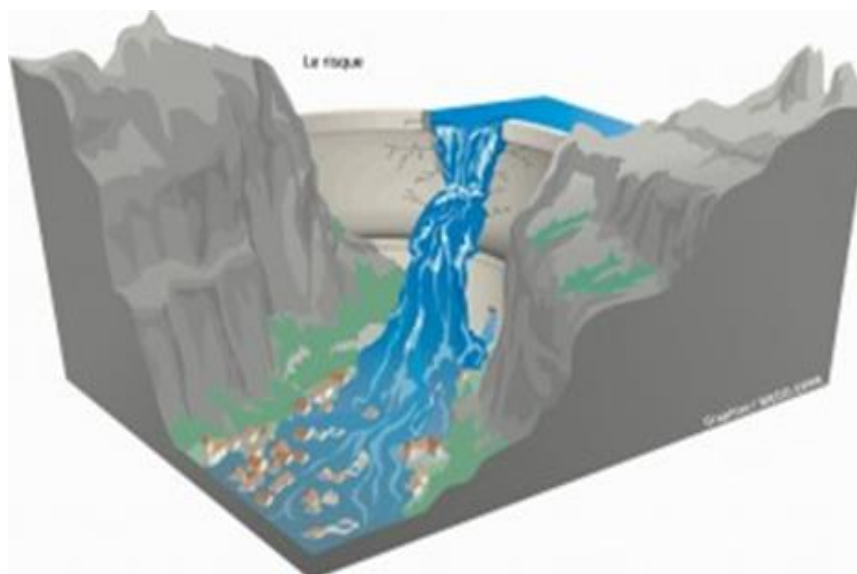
Exemple d'une inondation par rupture de protection.
